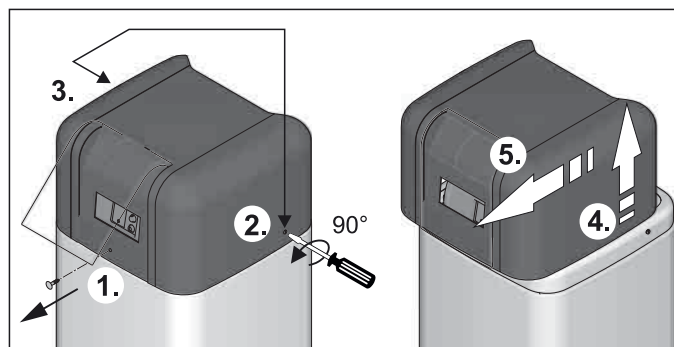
Dévisser / desserrer les vis, soulever la hotte de recouvrement à l'arrière et l'enlever par l'avant.
